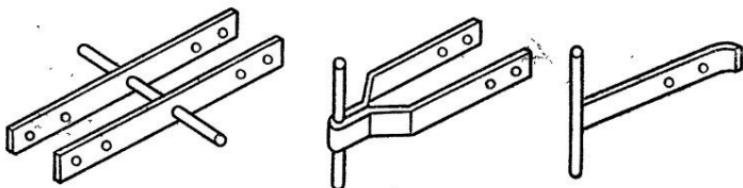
Анкеры для закрепления концов балок на капитальной и наружных стенах
